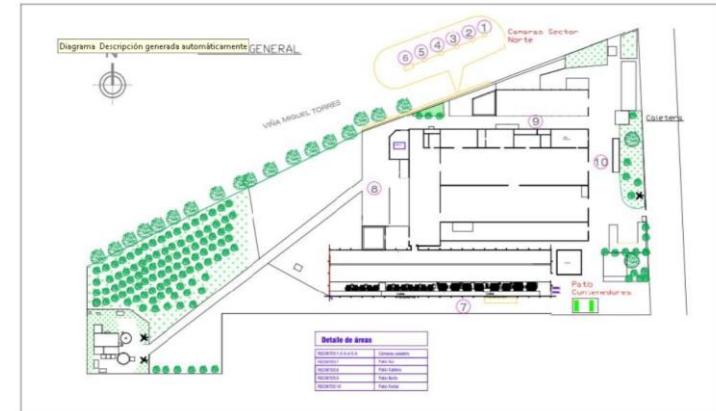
Plano de cámaras de inspección en el sistema de conducción de RILes que fueron restauradas e implementadas con marco metálico con pomeles y candados de seguridad.
